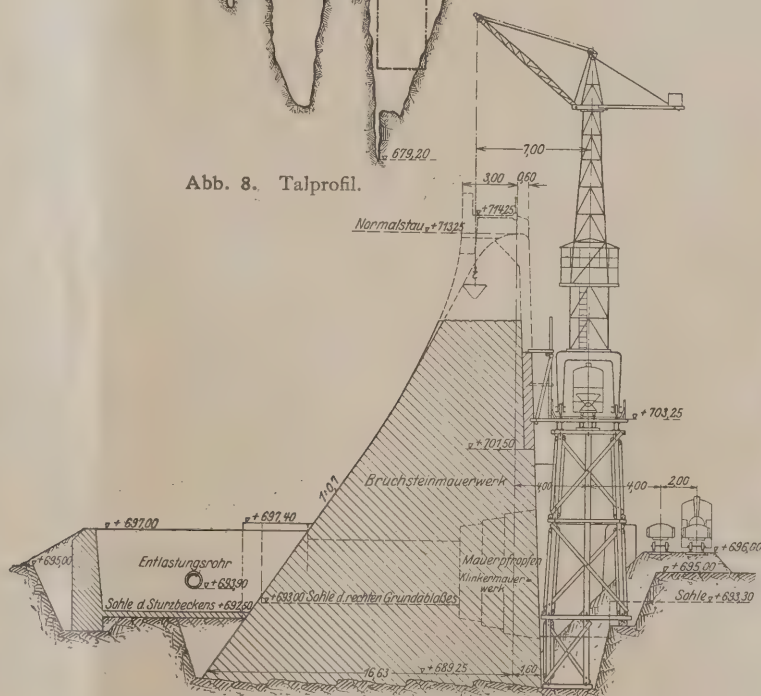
Schnitt durch die Sperrmauer mit Sturzbecken.
